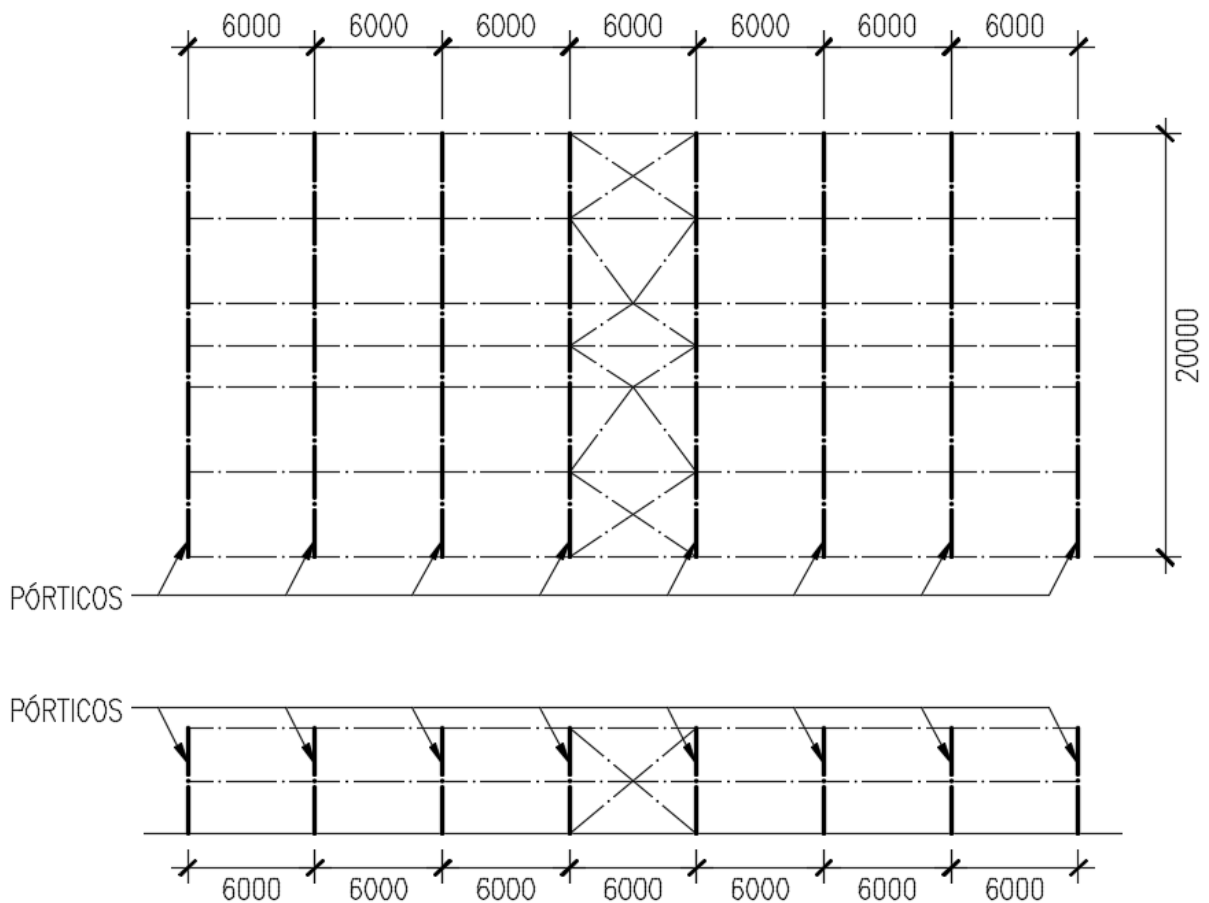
Planta y vista lateral (medidas en mm). Fuente: Elaboración propia.
